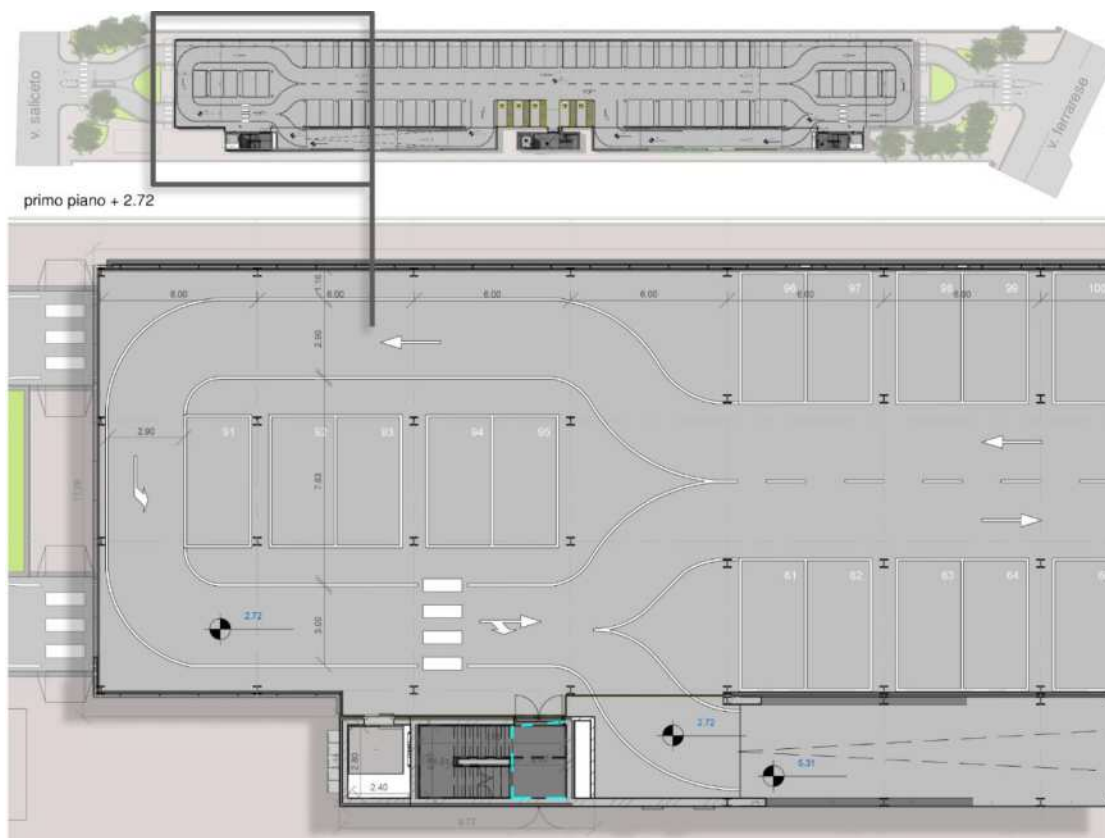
Pianta piano 1 e stralcio del lato ovest
